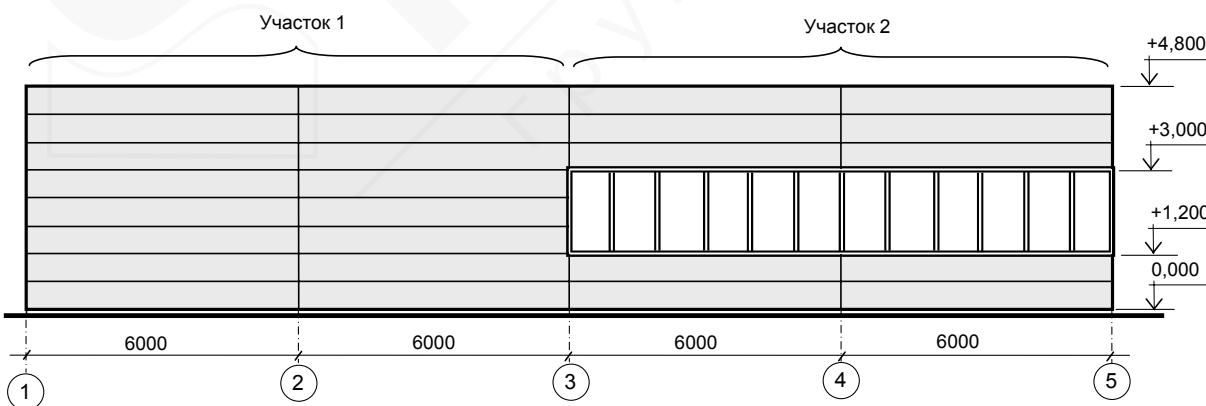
Схематичный фасад проектируемого здания (к примеру Е3)
